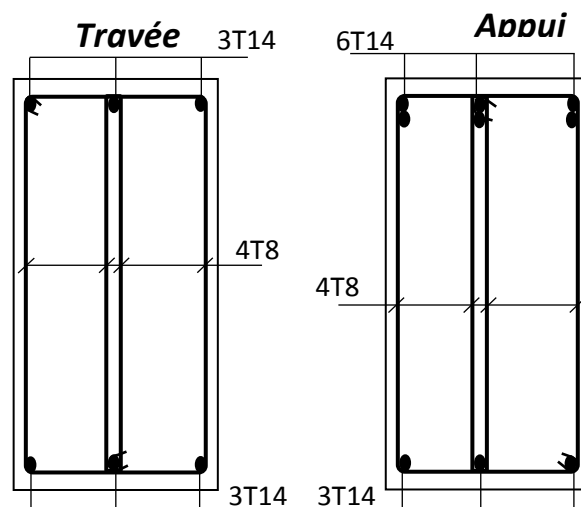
Schéma de Ferrailage des Poutres secondaire.
